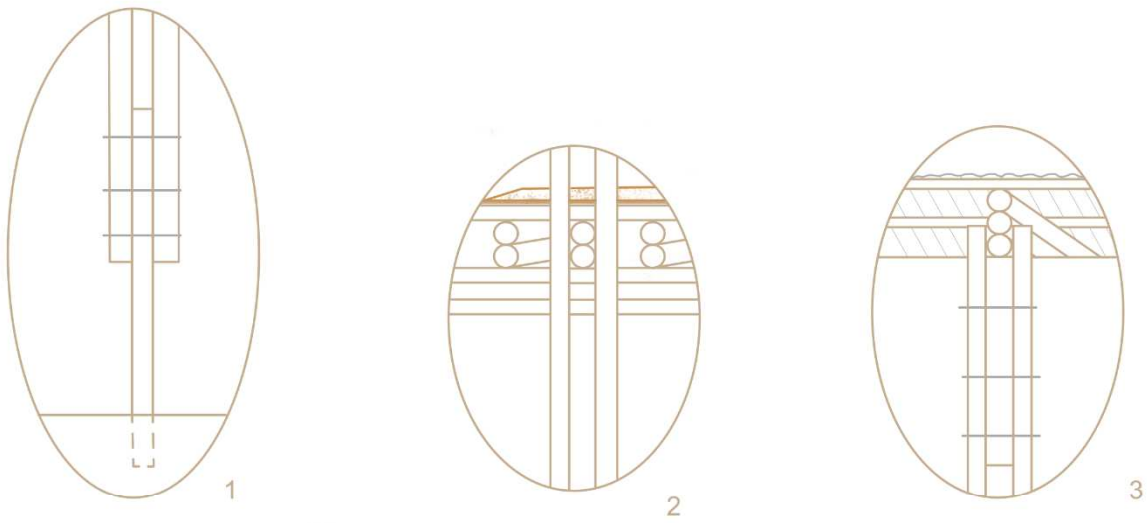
Plan et coupe détaillée du projet Desi Training Center d'Anna Heringer.
